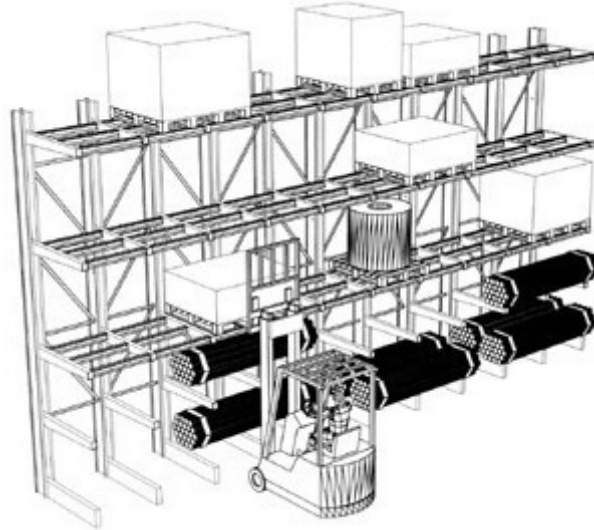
Vista esquemática de um sistema *cantilever* com plano de contraventamento alinhado às colunas, (Bertolini, 2004).
